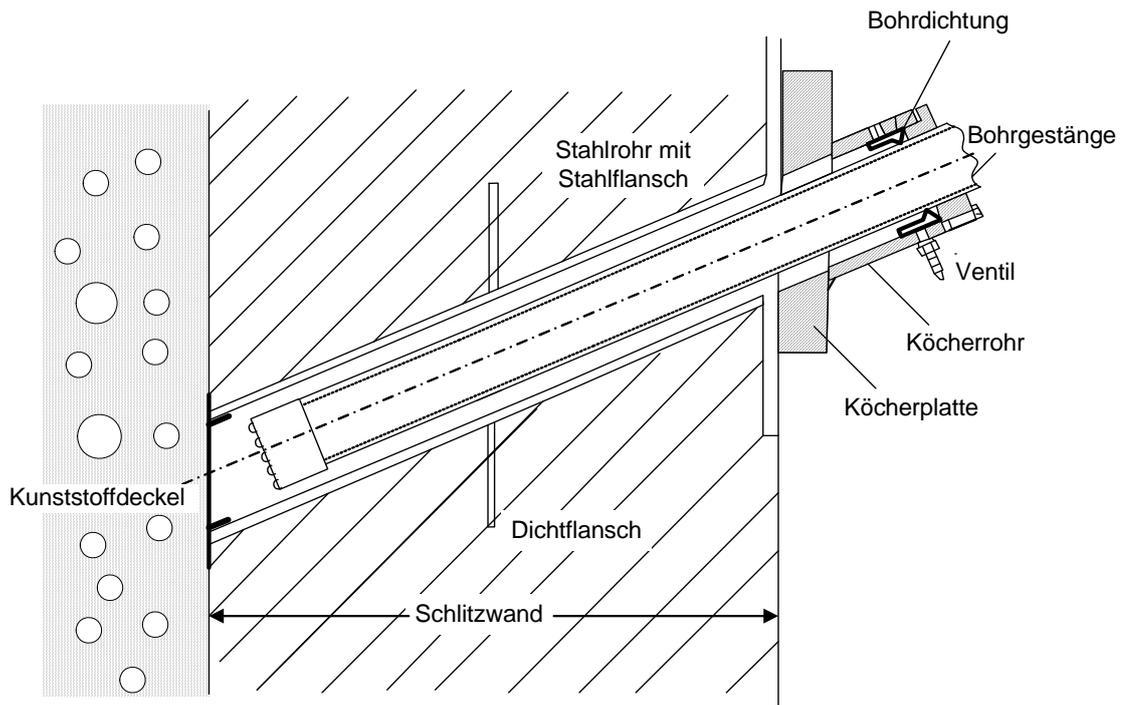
Bohrdichtungsbuchse – Schlitzwand
